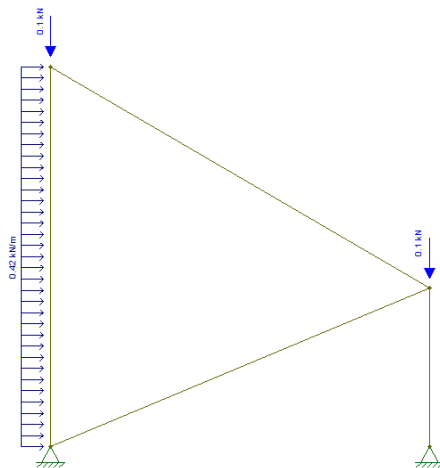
Estructura con las cargas. Fuente: www.ftool.com
